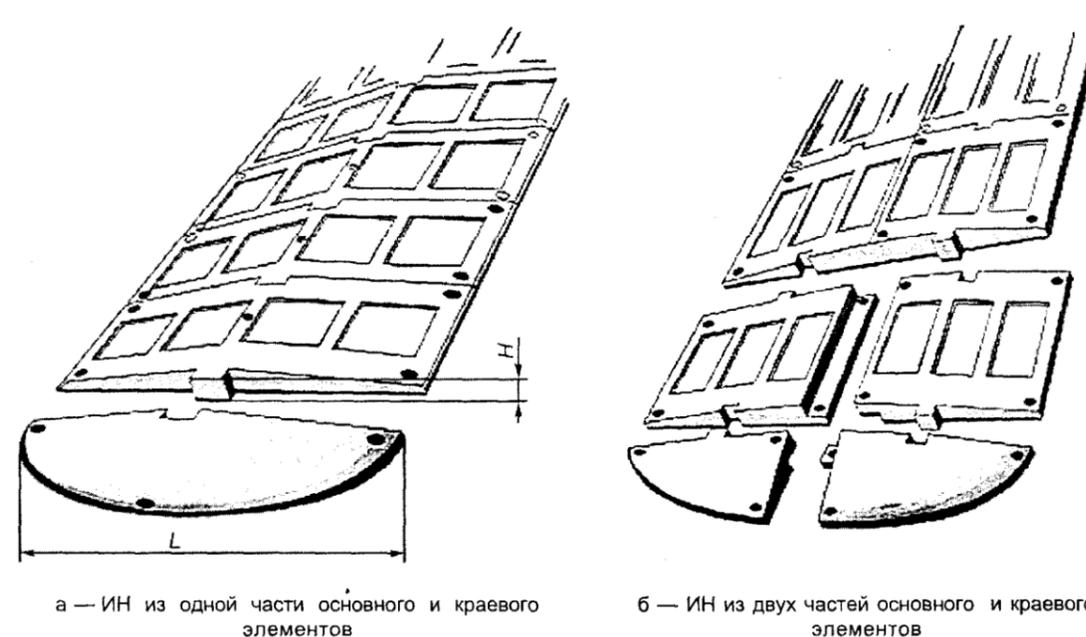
Конструкция сборно-разборной искусственной дорожной неровности
